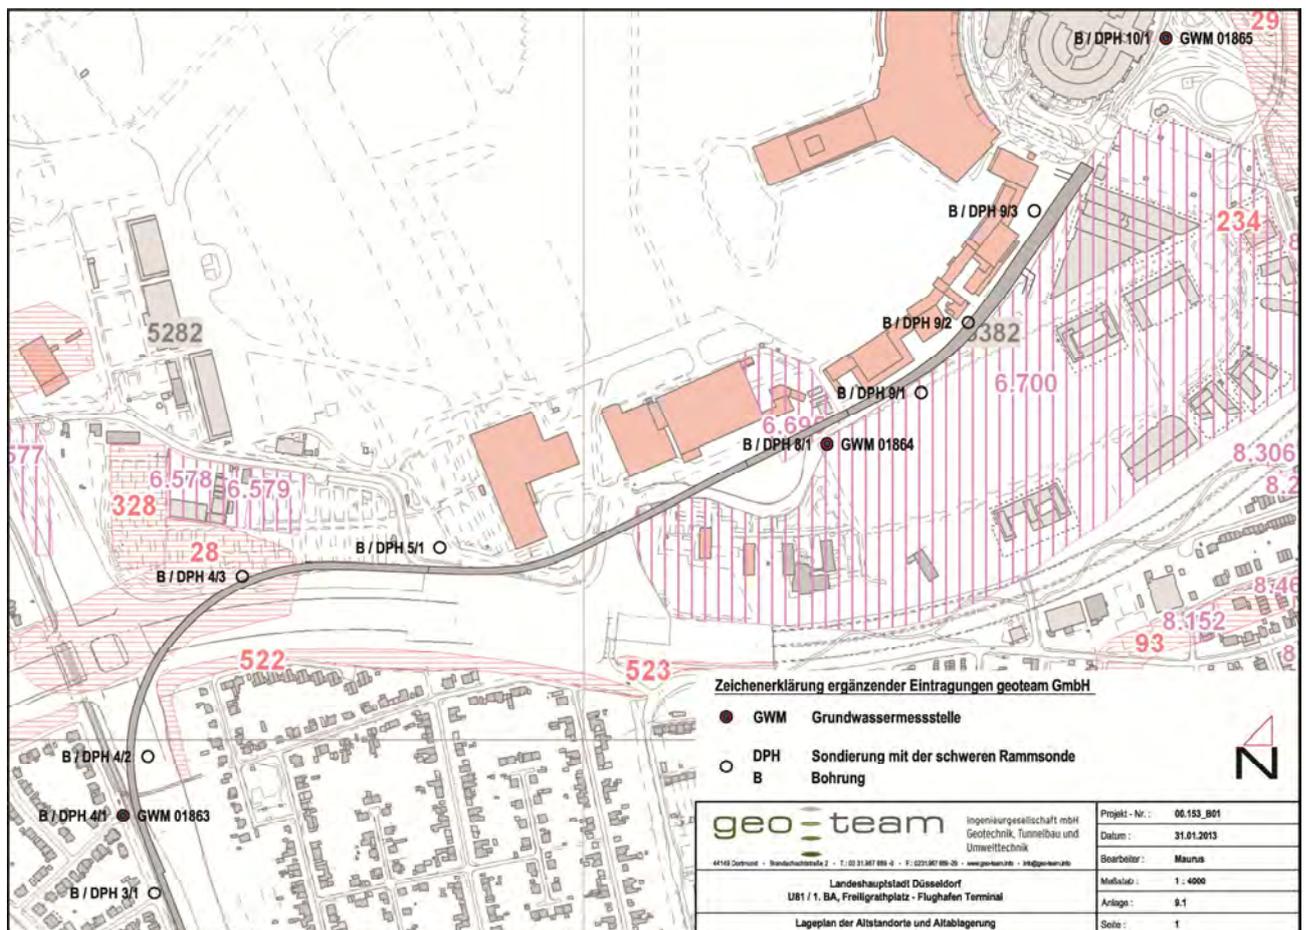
Lageplan der Altlasten und Altlastenverdachtsflächen nach [U 10], siehe auch Anlage 9.1
